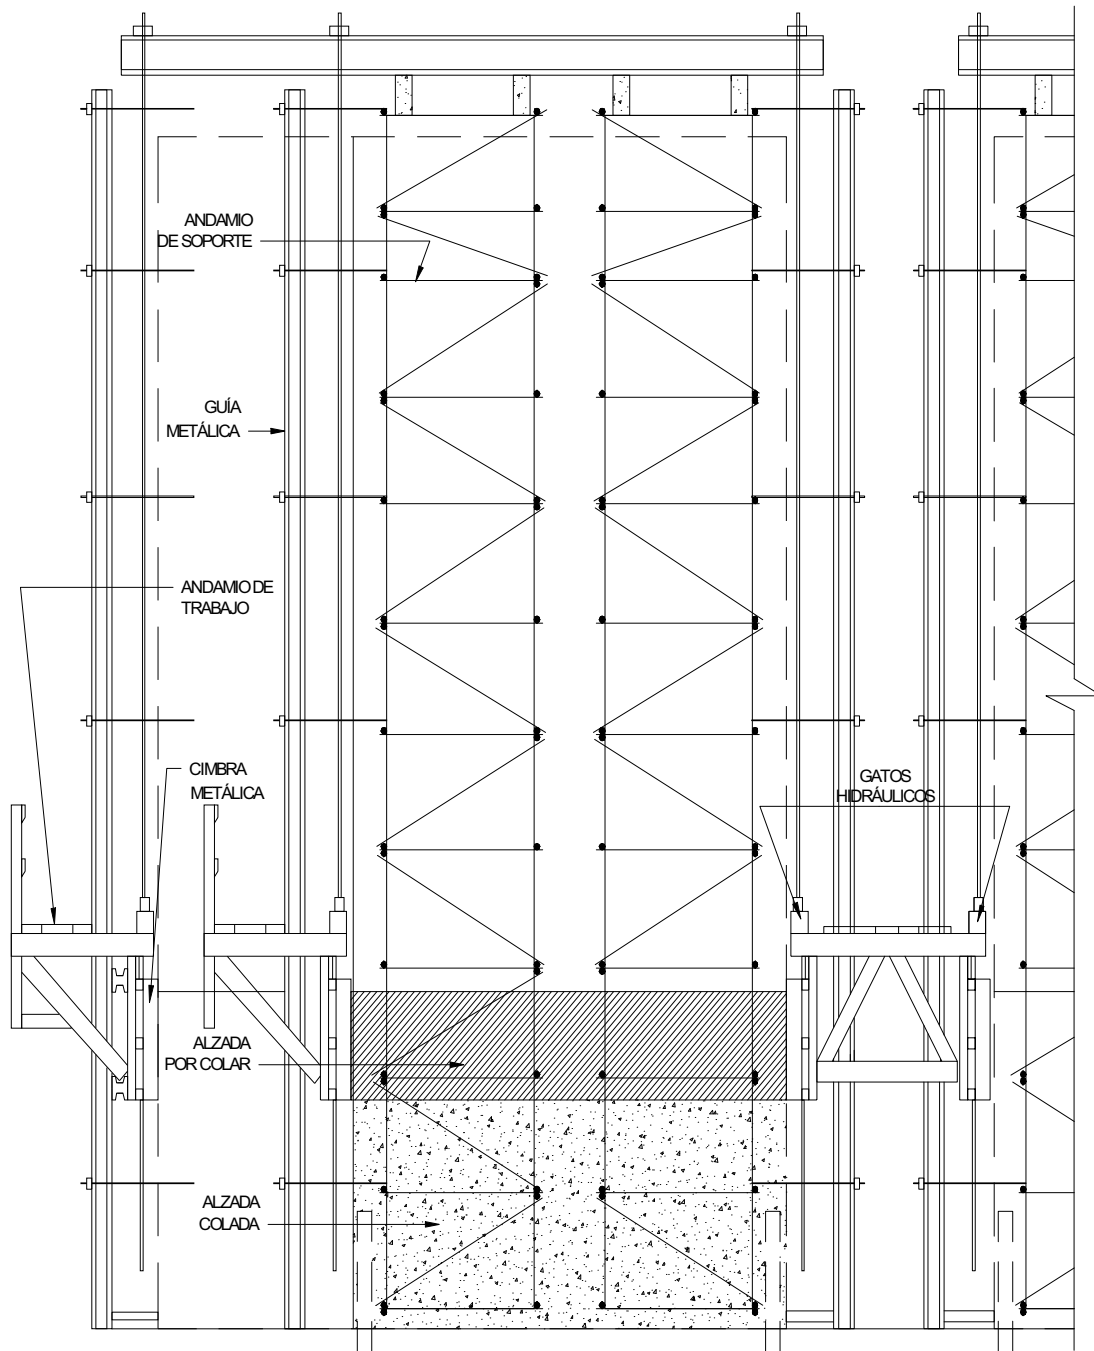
Zona de ubicación y disposición de la cimbra deslizante
